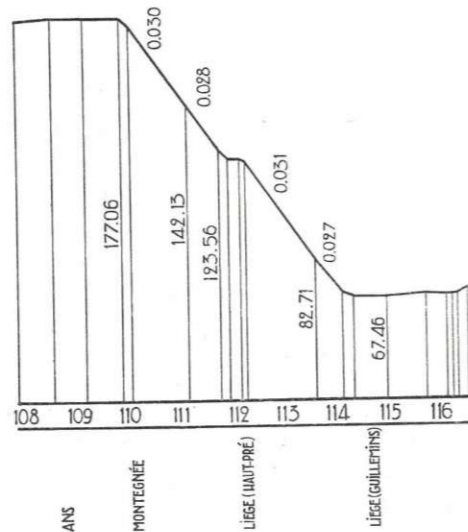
La rampe d'Ans (Ligne de Bruxelles-Liège-Frontière allemande).
